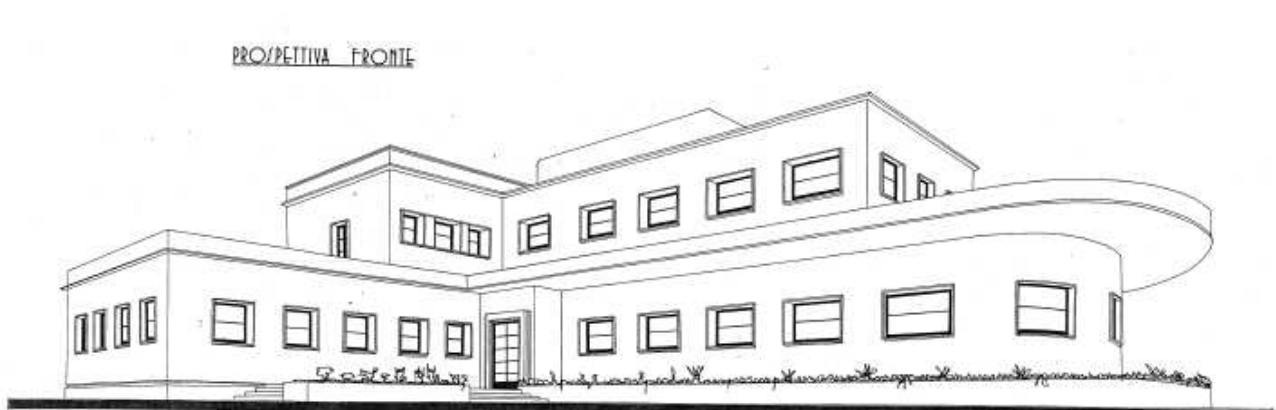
Prospettiva assometrica della seconda versione del progetto, vista direzione Nord-Ovest
